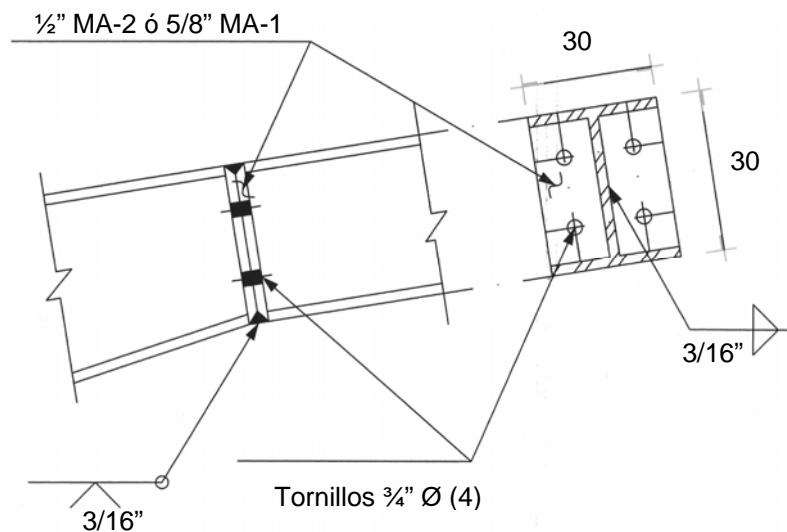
Detalles de soldadura en placas de conexión de semitrabes
